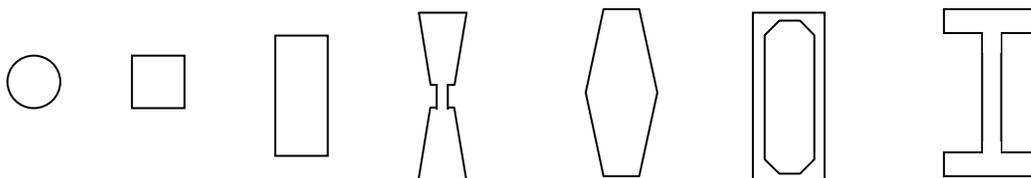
Algunas secciones típicas de pilas de grandes dimensiones.
